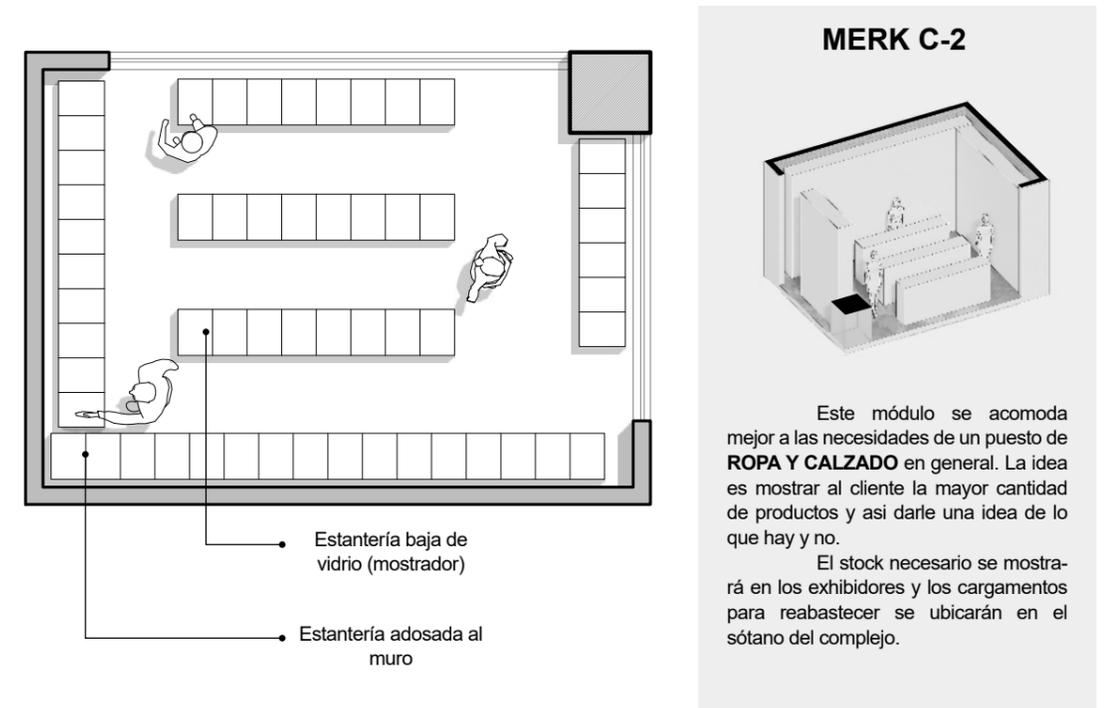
Planta módulo Merck C-2 Fuente: Elaboración propia
